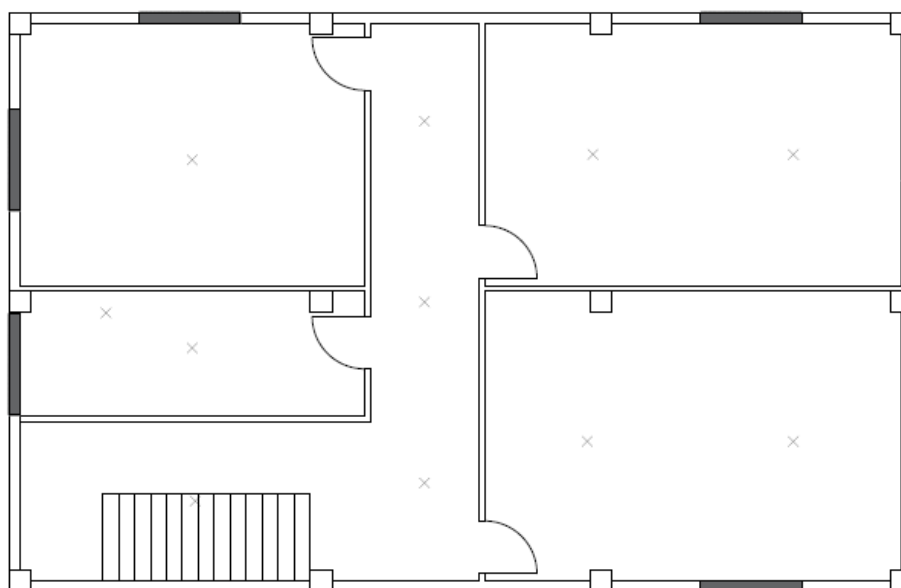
Plano Iluminación de la Vivienda Básica primera planta.
